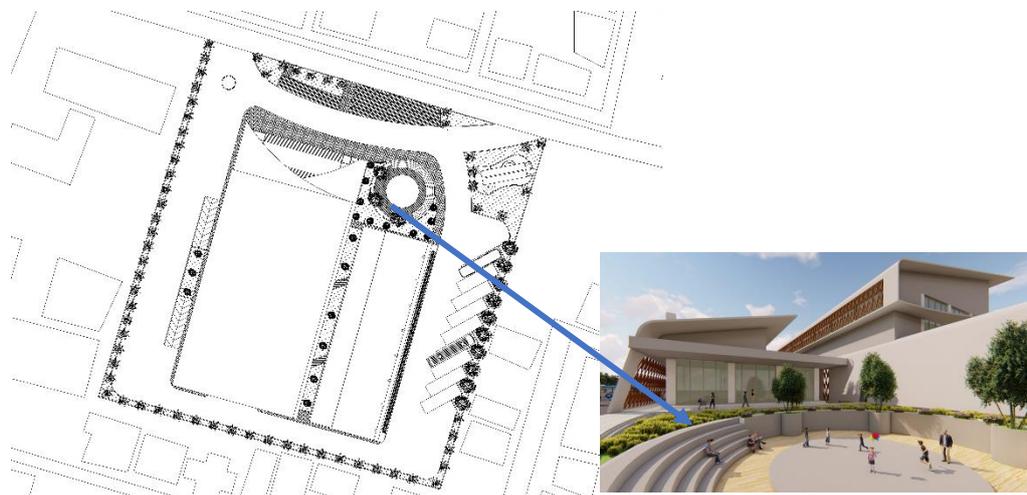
ruang pada massa bangunan topeng tertawa
